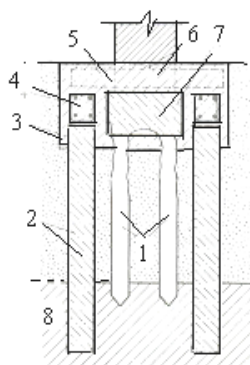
Усиление свайного фундамента с помощью выносных свай:
